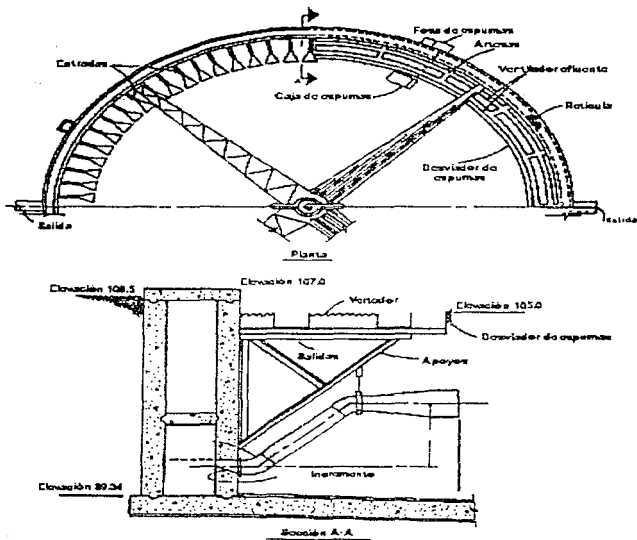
SEDIMENTADOR FINAL CON TOMA ELEVADA Y DIFUSOR MODIFICADO
